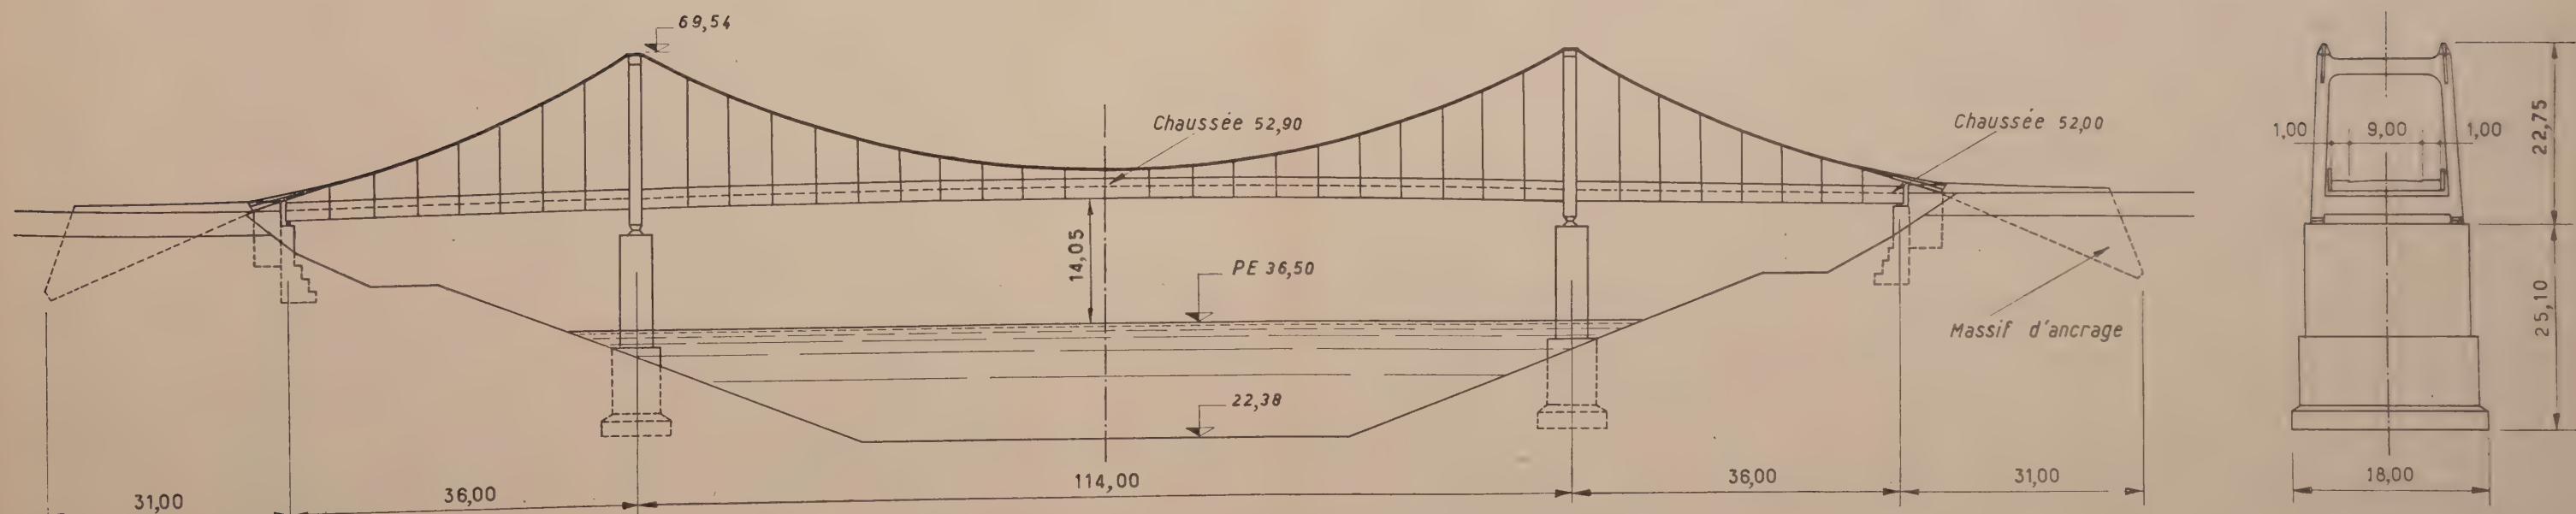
Pont de la R. N. 94 sur le canal de fuite. Élévation et coupe transversale.
